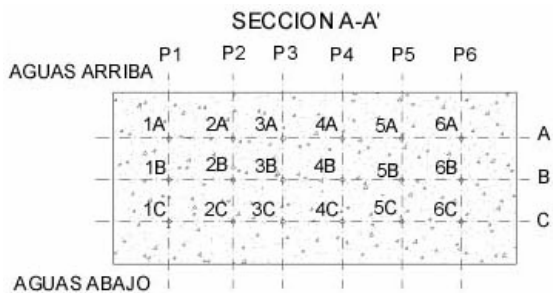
Proyección horizontal de la fisura y su intersección con los taladros de inyección.
